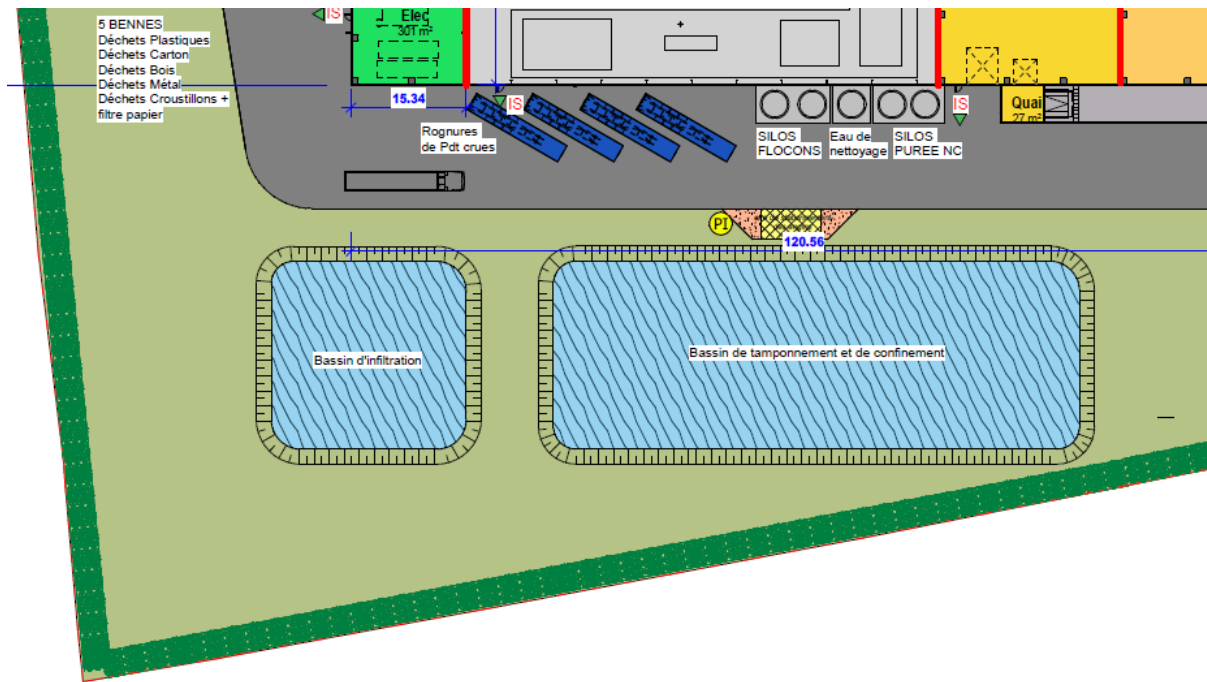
Zoom sur les ouvrages de tamponnement des eaux pluviales - Bassin versant Sud
